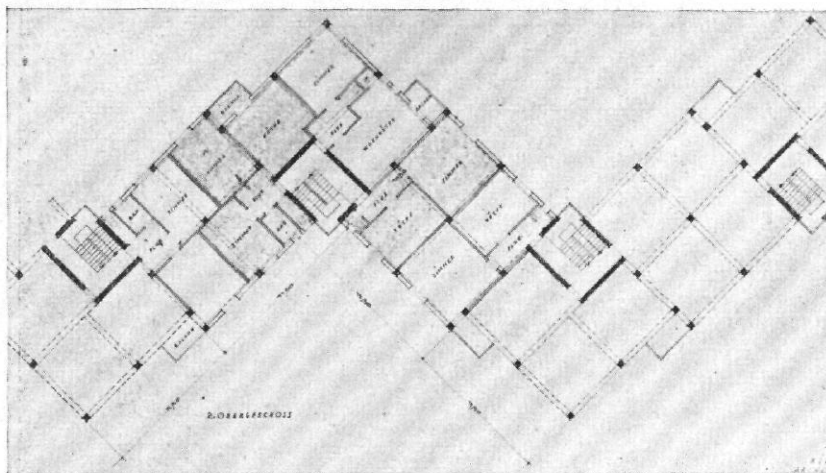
und 8 / Siedlung Köln-Kalkerfeld / Lageplan 1:5000, darüber Grundrisse der Randbebauung 1:250 / Architekten: Ripbahn und Grod, Köln
